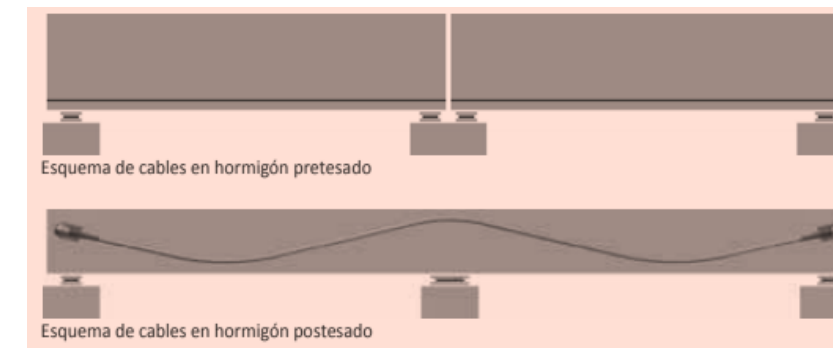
Esquemas de cables en hormigón pretensado y postesado.
